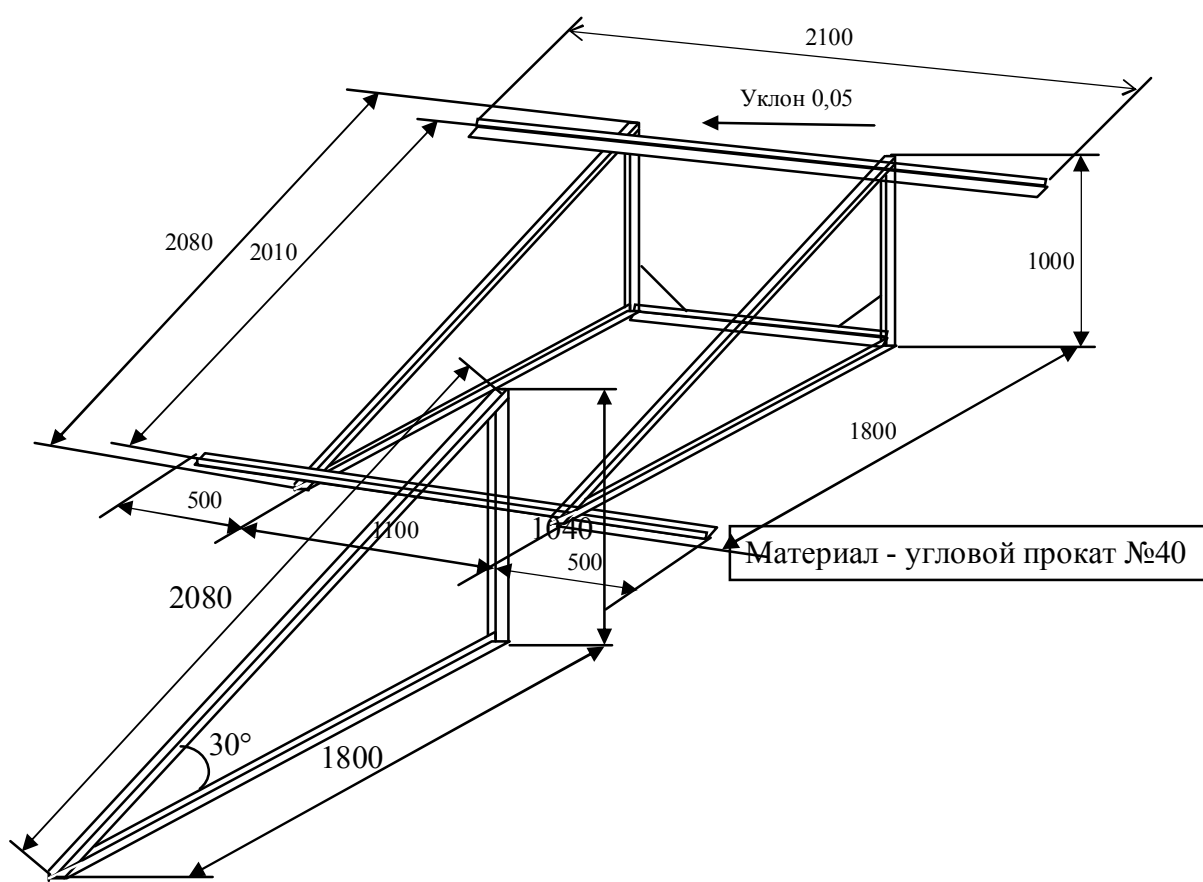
Фундаментная рама для монтажа двух солнечных коллекторов на плоской кровле
